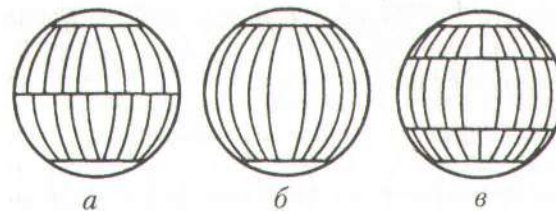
Схеми розкрою корпусів сферичного резервуара
